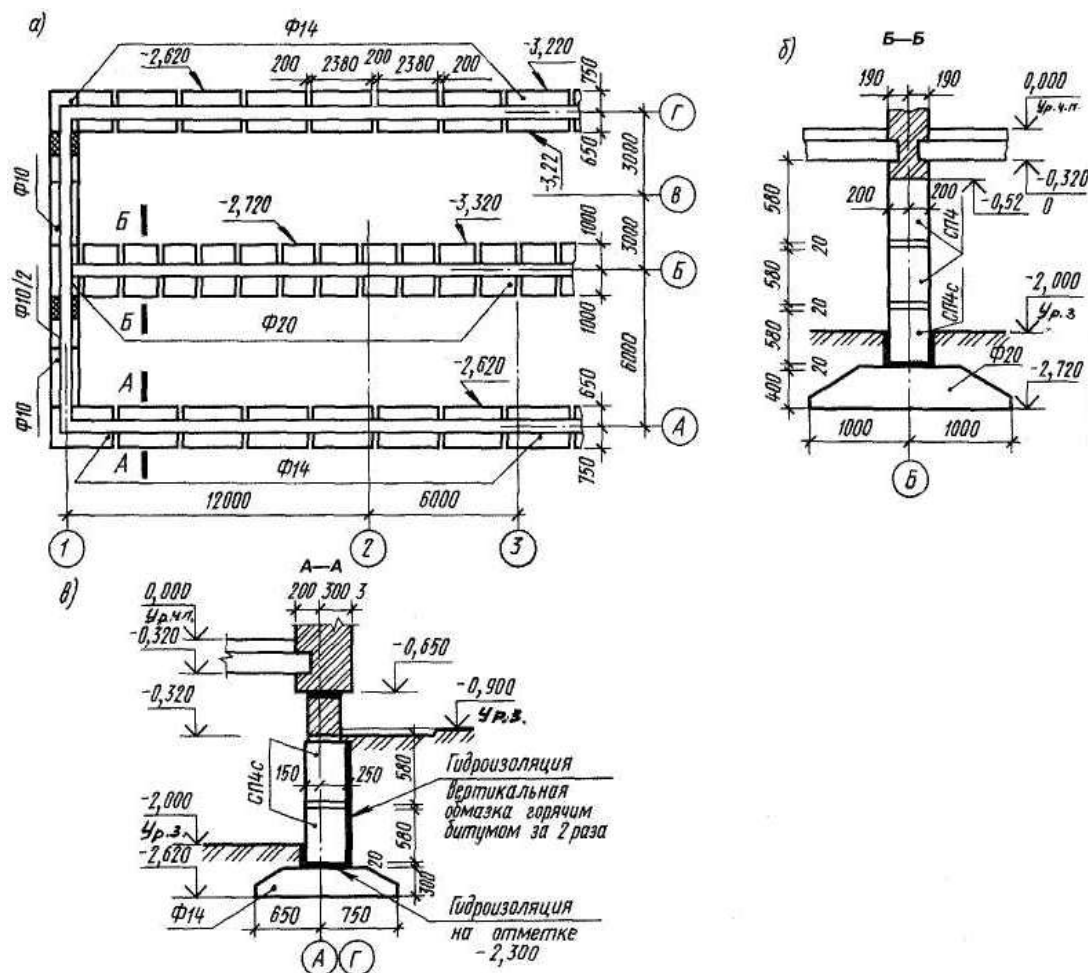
Схема расположения элементов фундамента (а), сечение фундаментов по внутренней (б) и наружной стене (в)
